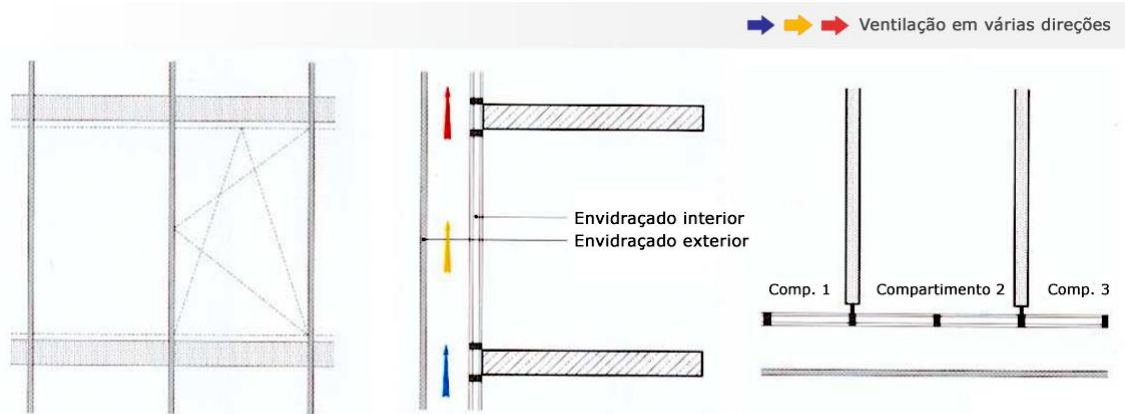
Geometria e esquema geral de ventilação de uma fachada do tipo “Multi-Piso” (vista frontal – corte em perfil – corte horizontal) [adaptado de Oesterle, Lieb, e Green (2001)]
